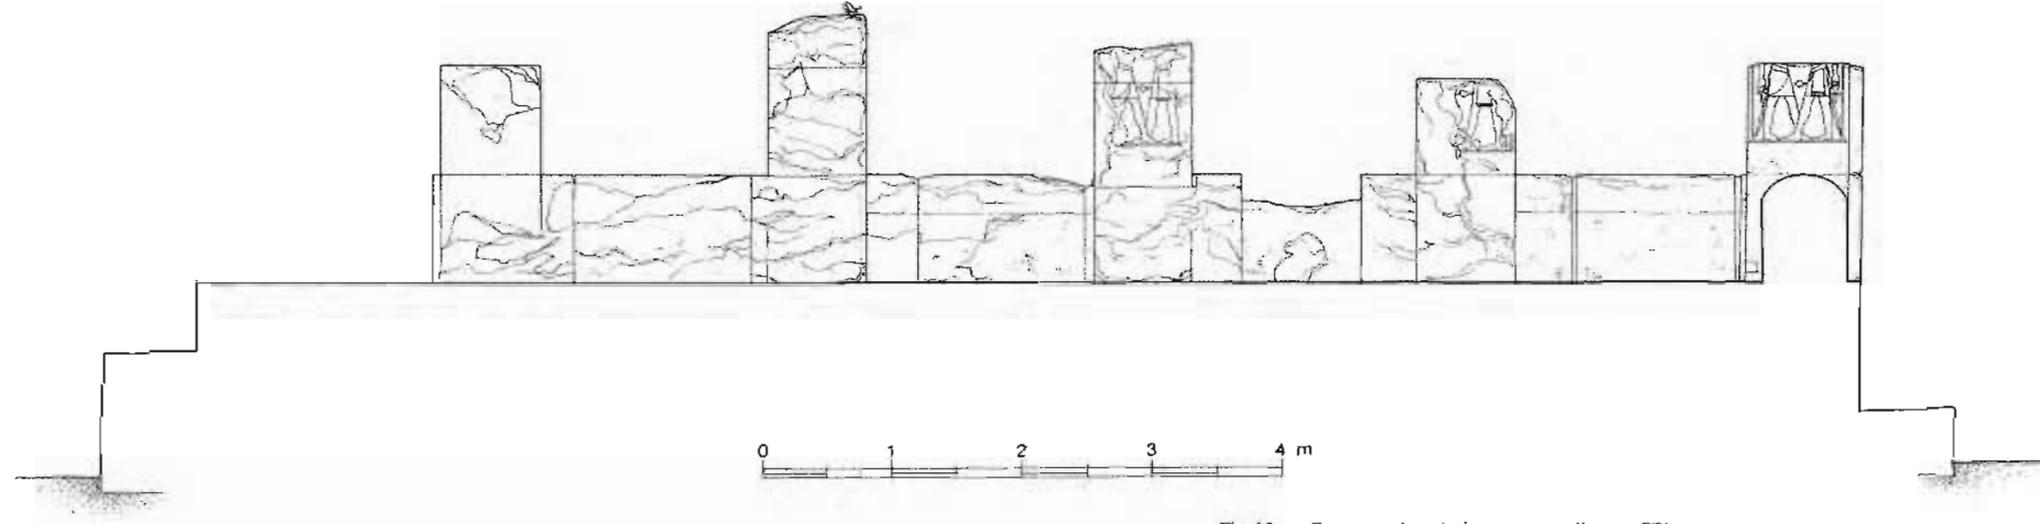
Coupe sur la galerie ouest vers l'ouest, PP'.
